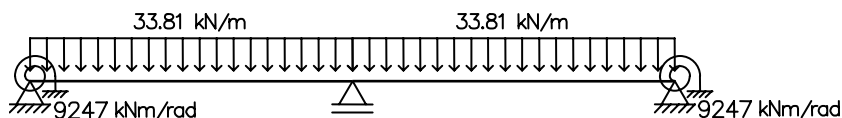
Esquema estrutural e carregamento da viga V_{S1} , isolada do pórtico plano do Exemplo 2.
